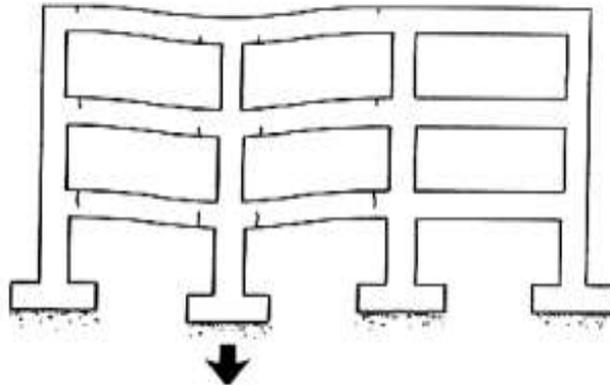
Evidencia de grietas en vigas de un pórtico, por asentamientos. [52]
